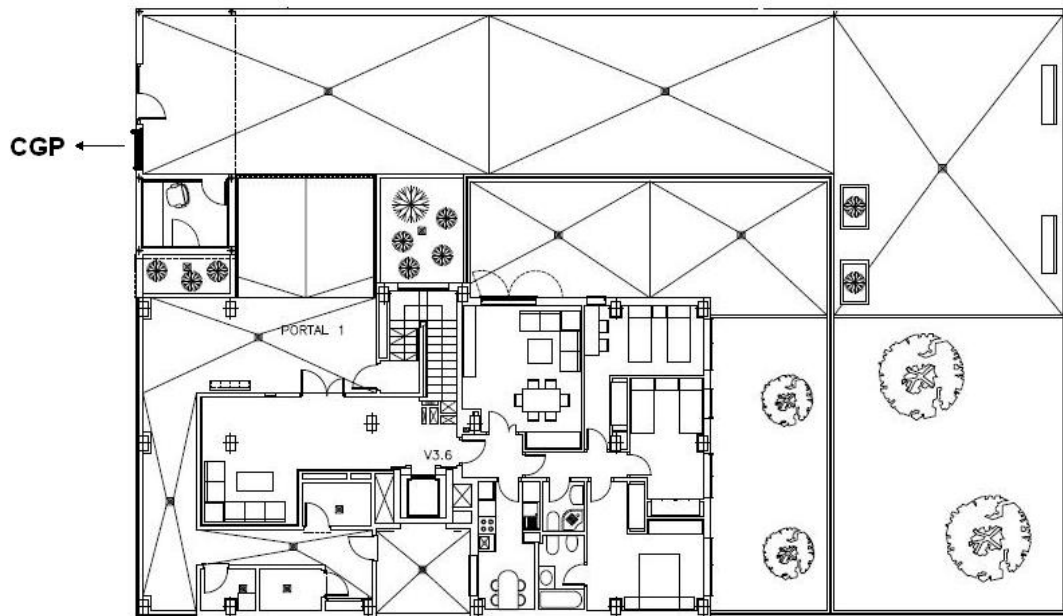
Planta baja con caja general de protección (CGP)
